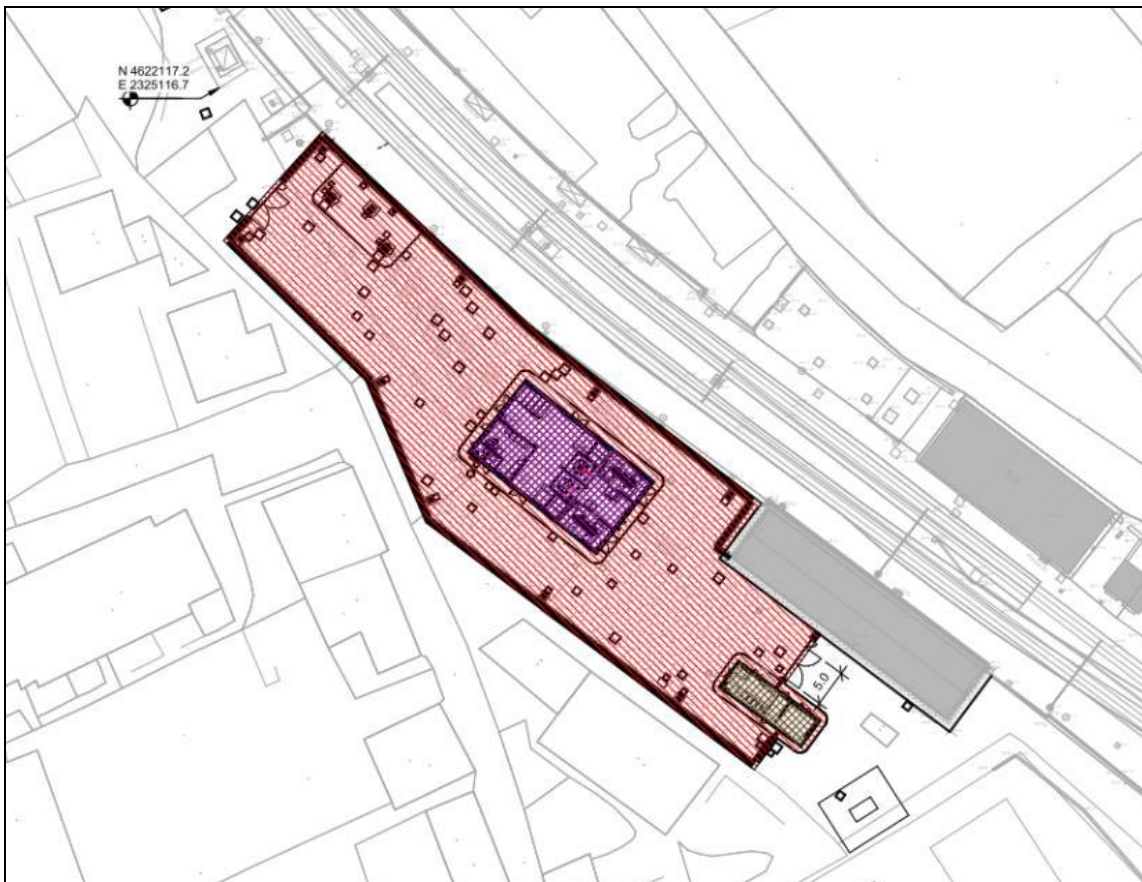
Pianta piazzale nuova SSE di Albano Laziale
